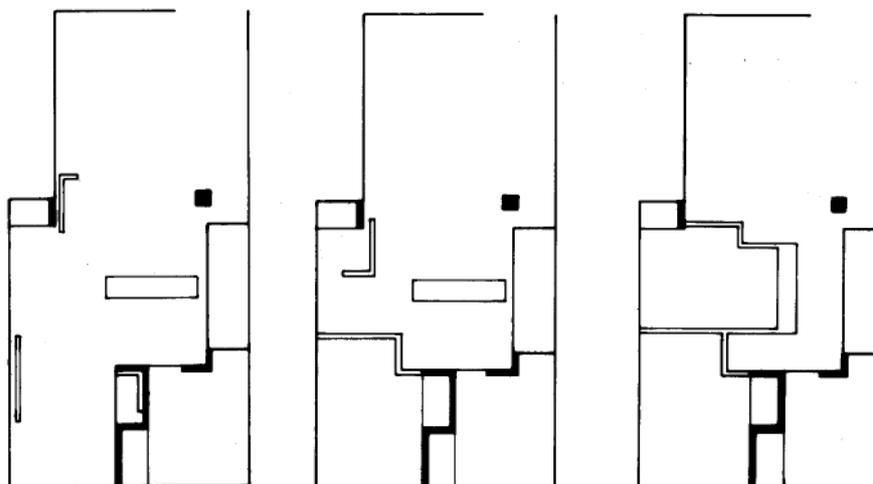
PLANTAS DOS APARTAMENTOS EM FUKUOKA, JAPÃO
